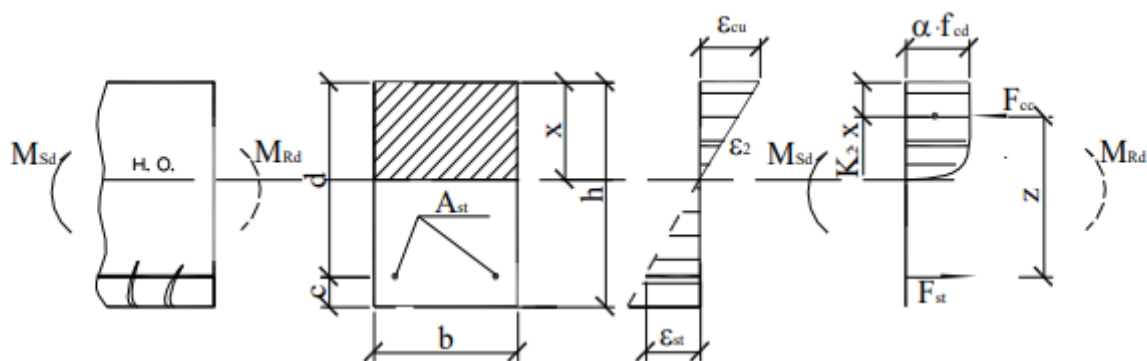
Схема распределения относительных усилий при определении предельного момента для прямоугольного сечения с одиночным армированием.
